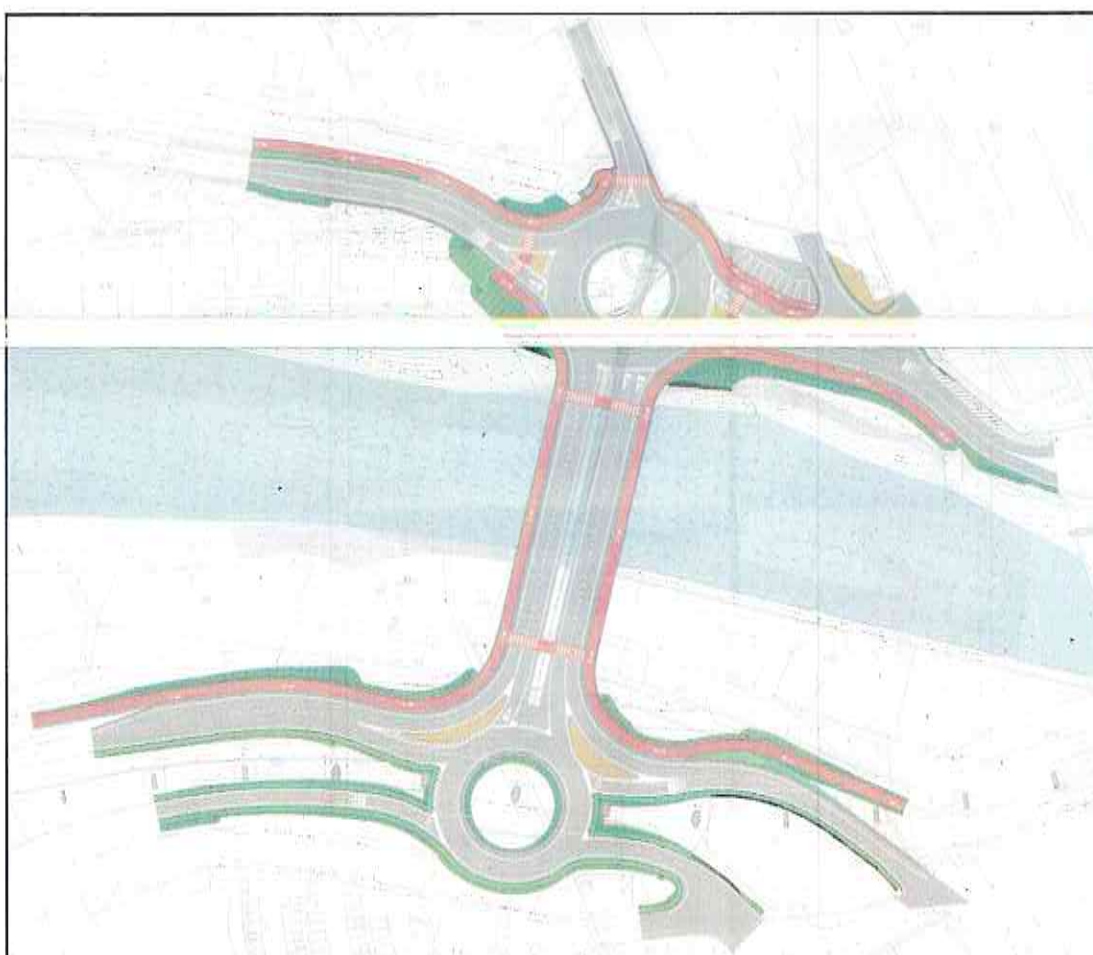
Planimetra di progetto del Ponte Nuovo a Pescara.
